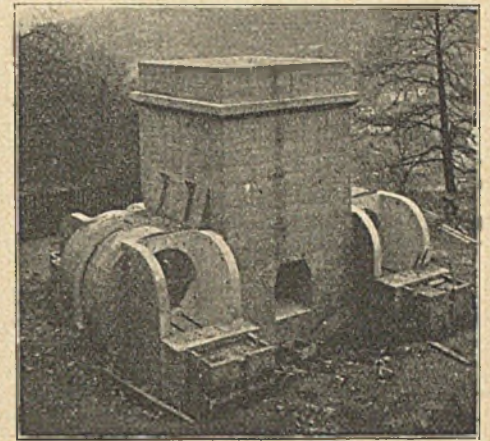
Das Maschinengehäuse im Bau ohne Haus.
